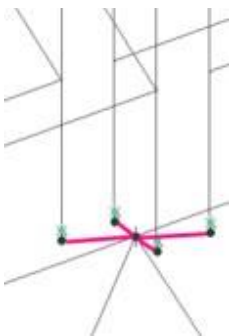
Моделирование опирания колонны модуля на стальную ферму
